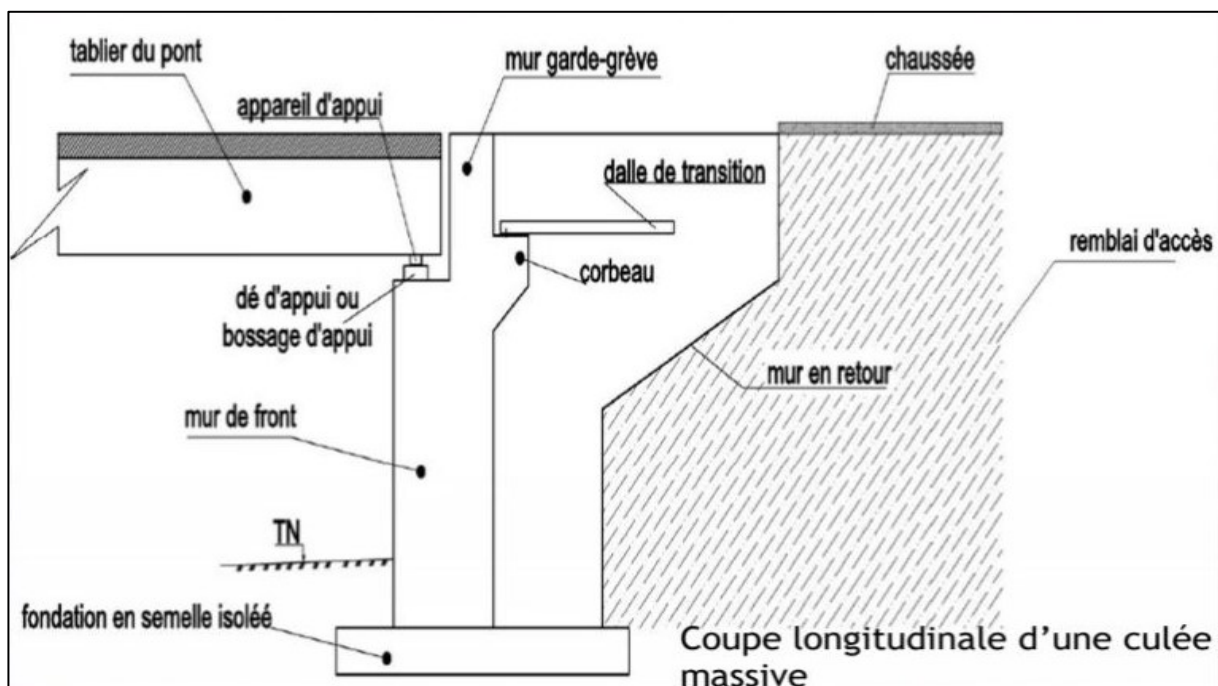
Coupe longitudinale .IX.3.2 Les divers types de culées :
